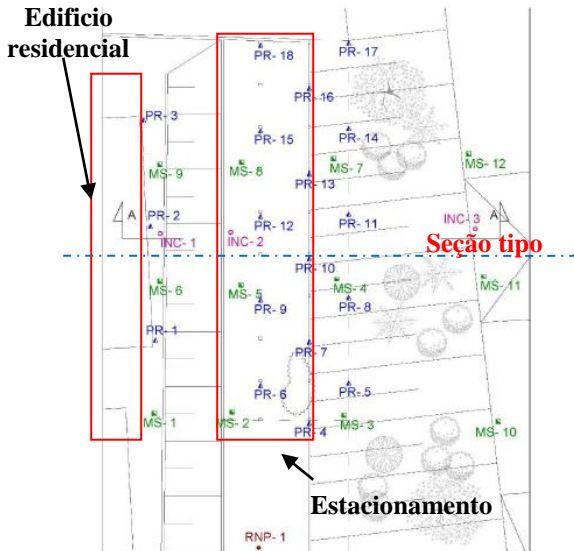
Planta de locação dos instrumentos previstos pelo plano de instrumentação geotécnica. Localização do edifício residencial e da estrutura do estacionamento.
